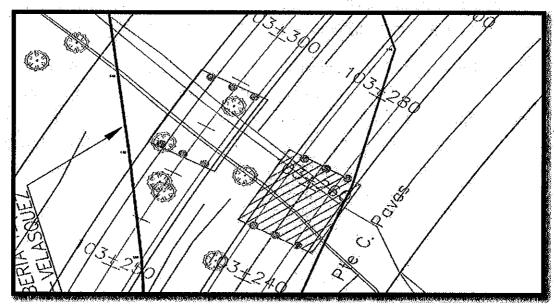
acercamientos críticos con estructuras viales (Puentes) e infraestructura petrolera
